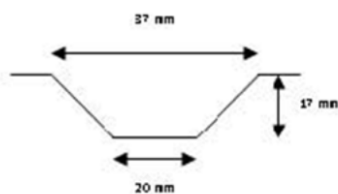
Armatures spéciales pour panneaux à bossage en U 37 (dimensions en mm)
